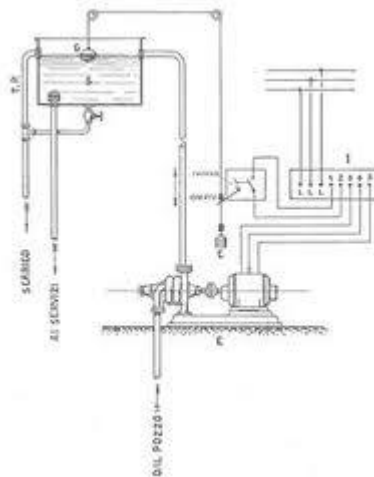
Esempio di impianto con serbatoio sopraelevato
